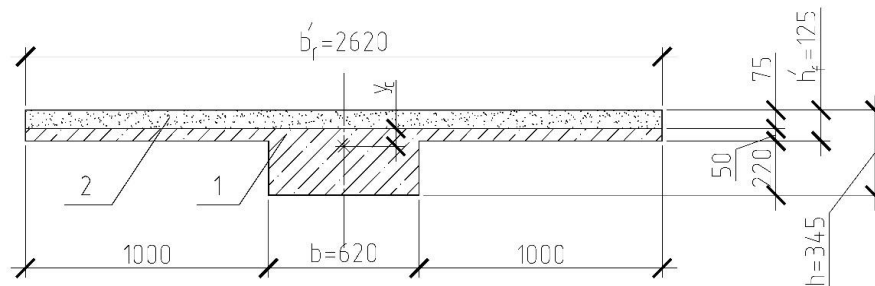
Поперечное сечение усиленного ригеля: 1 – старый бетон; 2 – новый бетон
